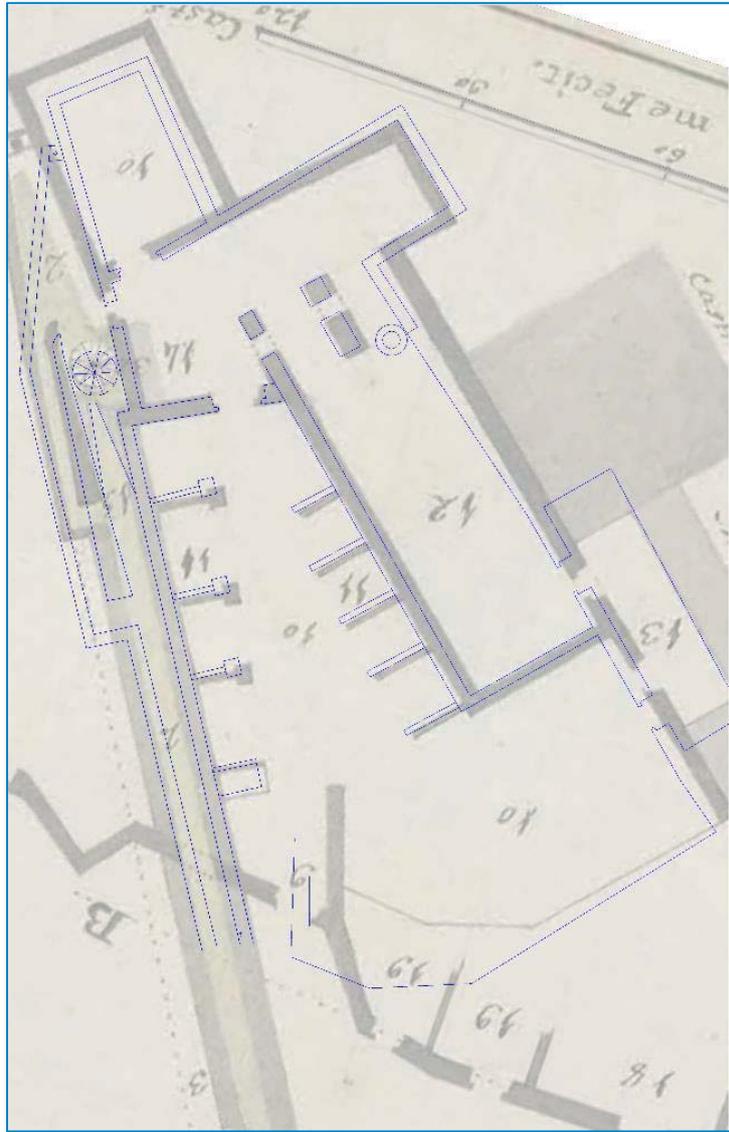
Adaptación de la planta del plano original de Leyba (1802) al plano Arqueológico levantado con estación total.
